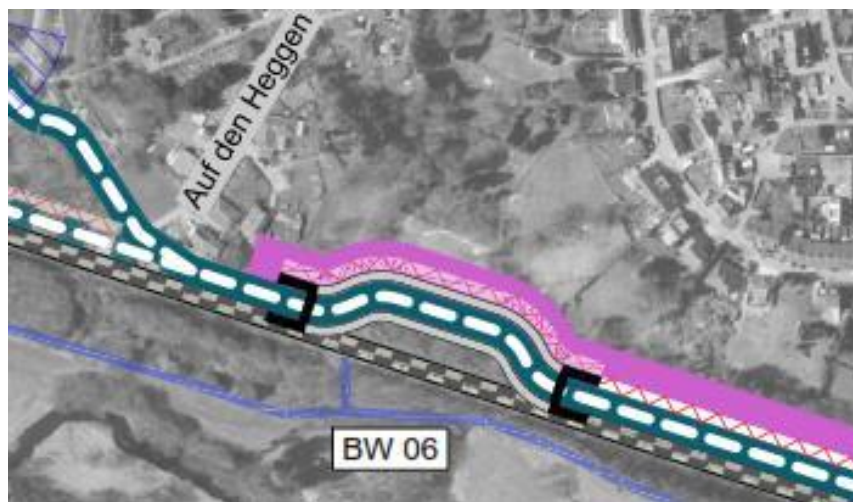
Lage BW 06 – Überführung Senke Heggen
